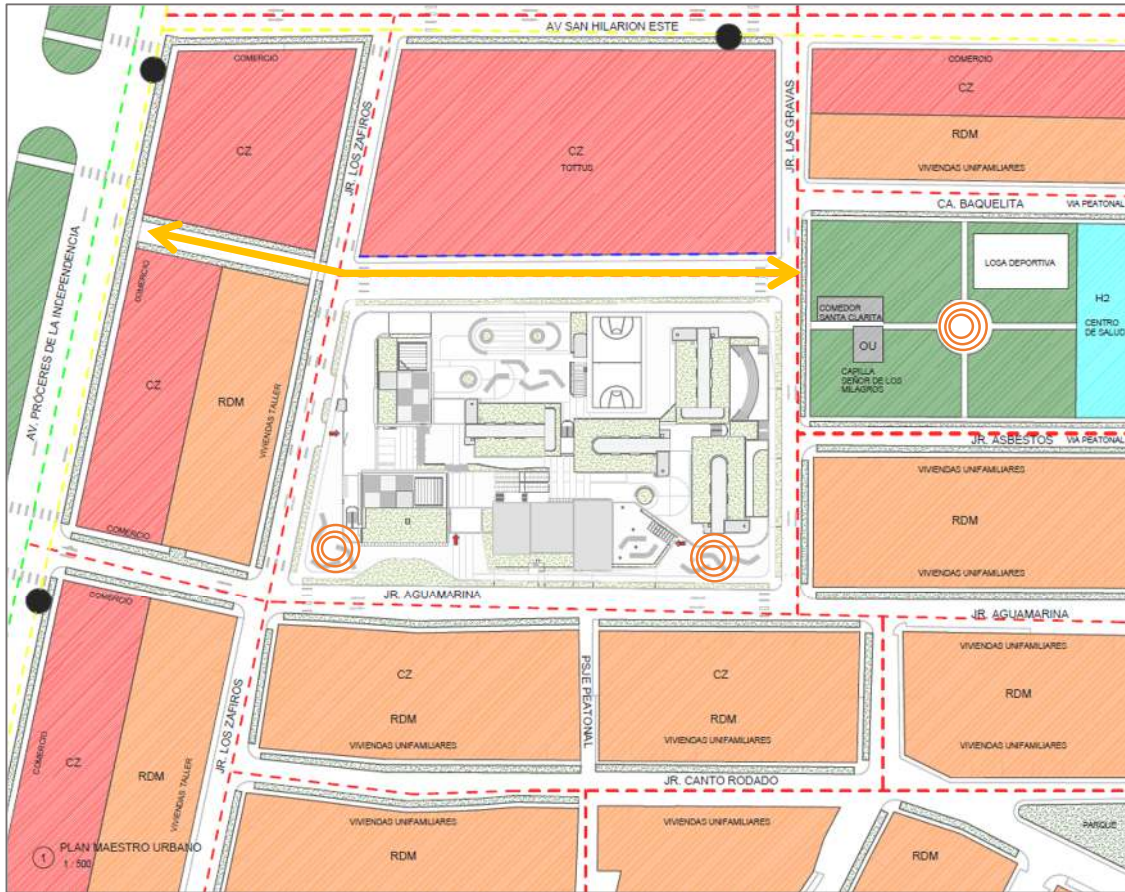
Plan Maestro Urbano. - Fuente: Elaboración propia.
